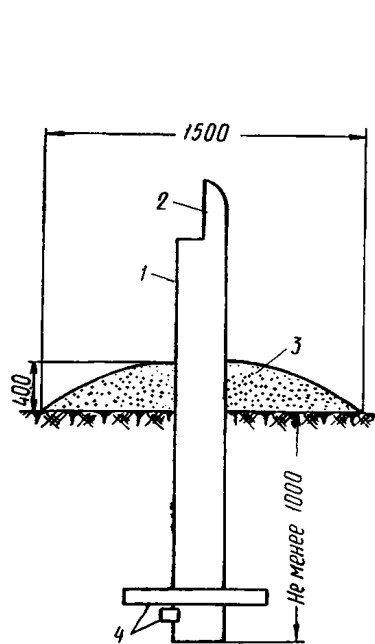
Центр для закрепления осей трасс и опознавательный столб
